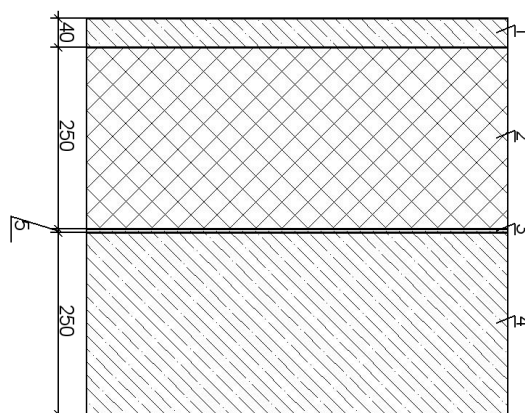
Схема конструкции ограждающей конструкции кровли
